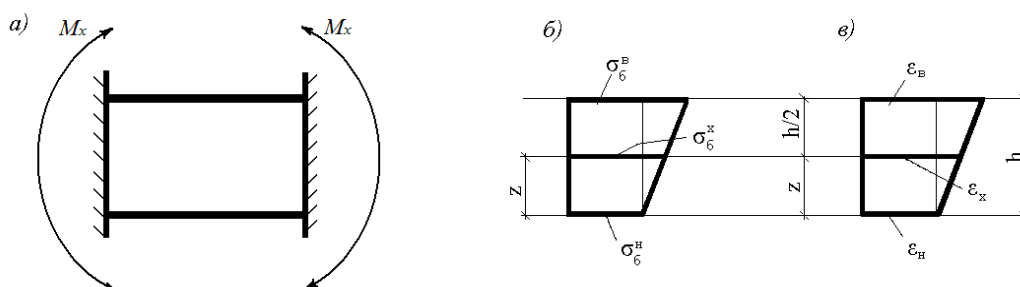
Схемы к расчету опертой по контуру плиты из самоупроченного бетона
